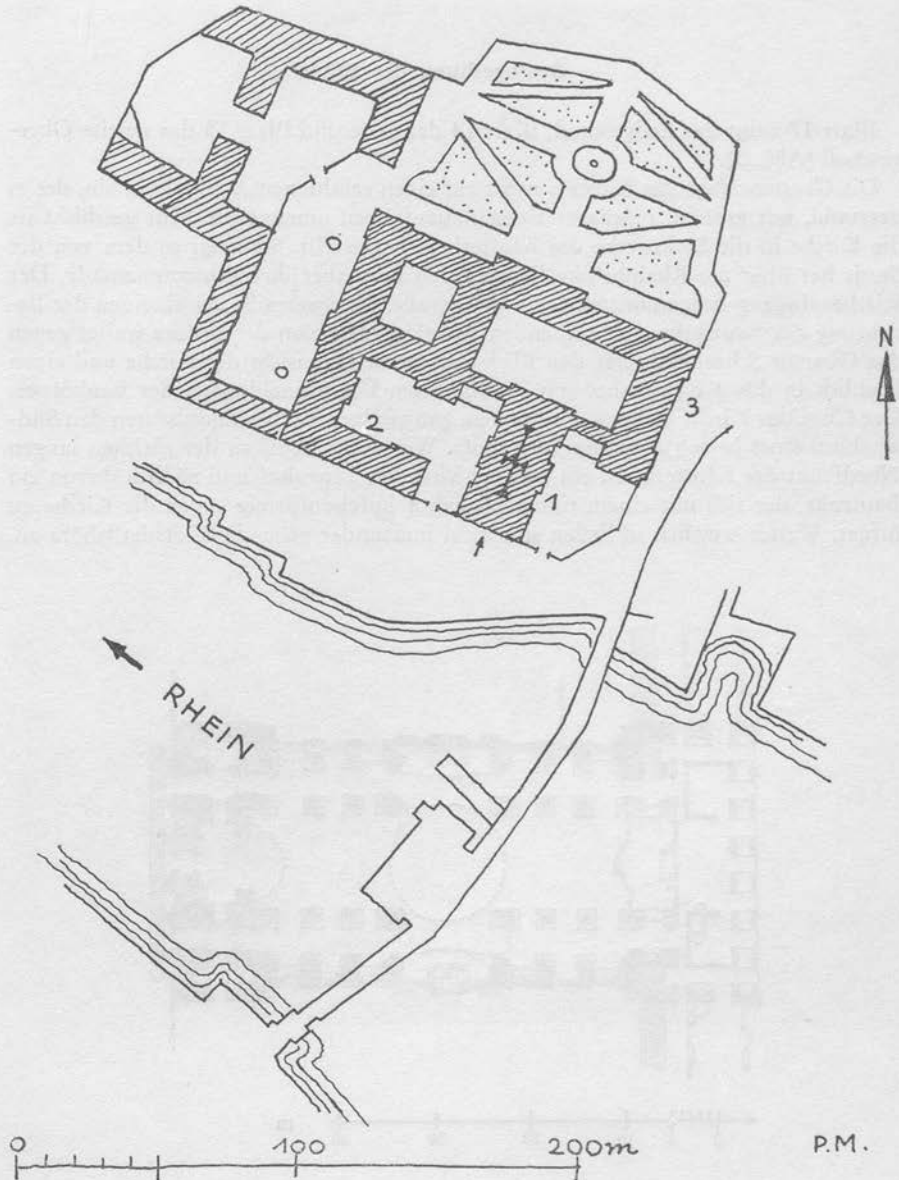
Lageplan Kloster zu Plan Nr. 17 (de la Guèpière 1765)
